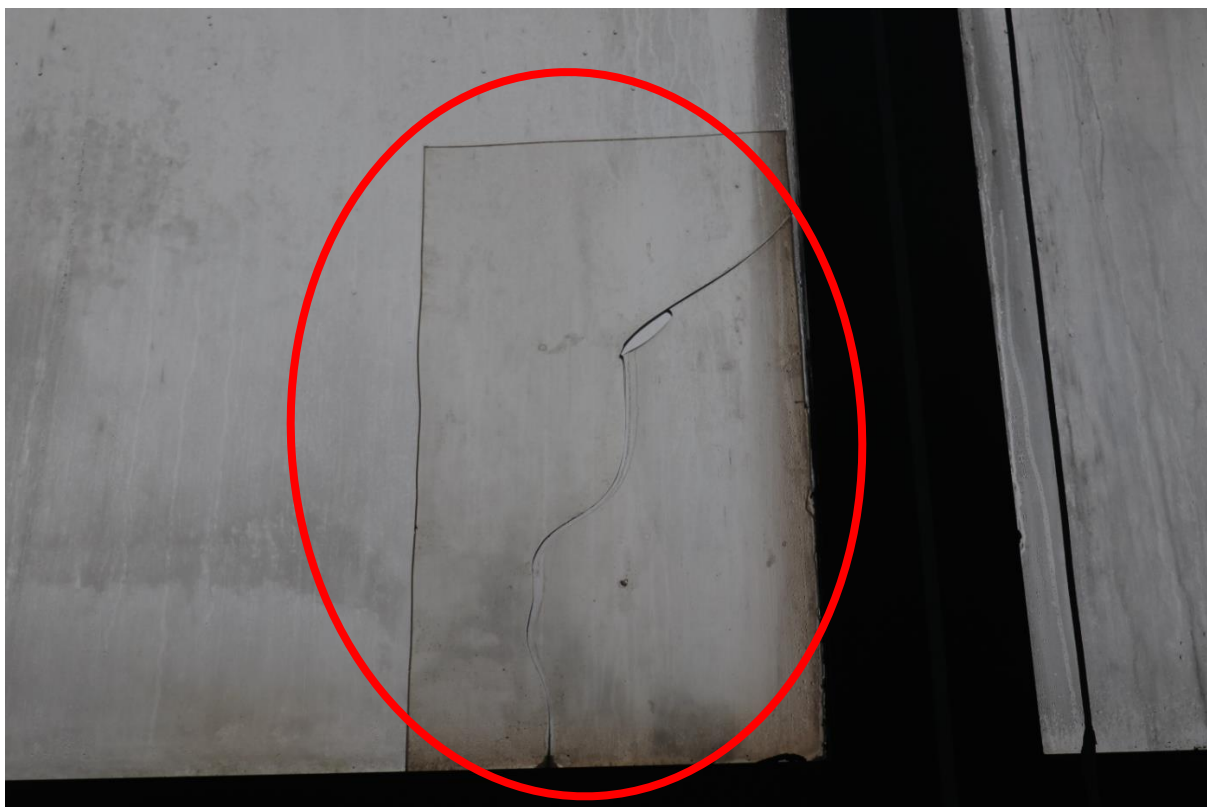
Pohled na provizorní opravu opláštění plaveckého 50m bazénu a zatékání vody do opláštění.
